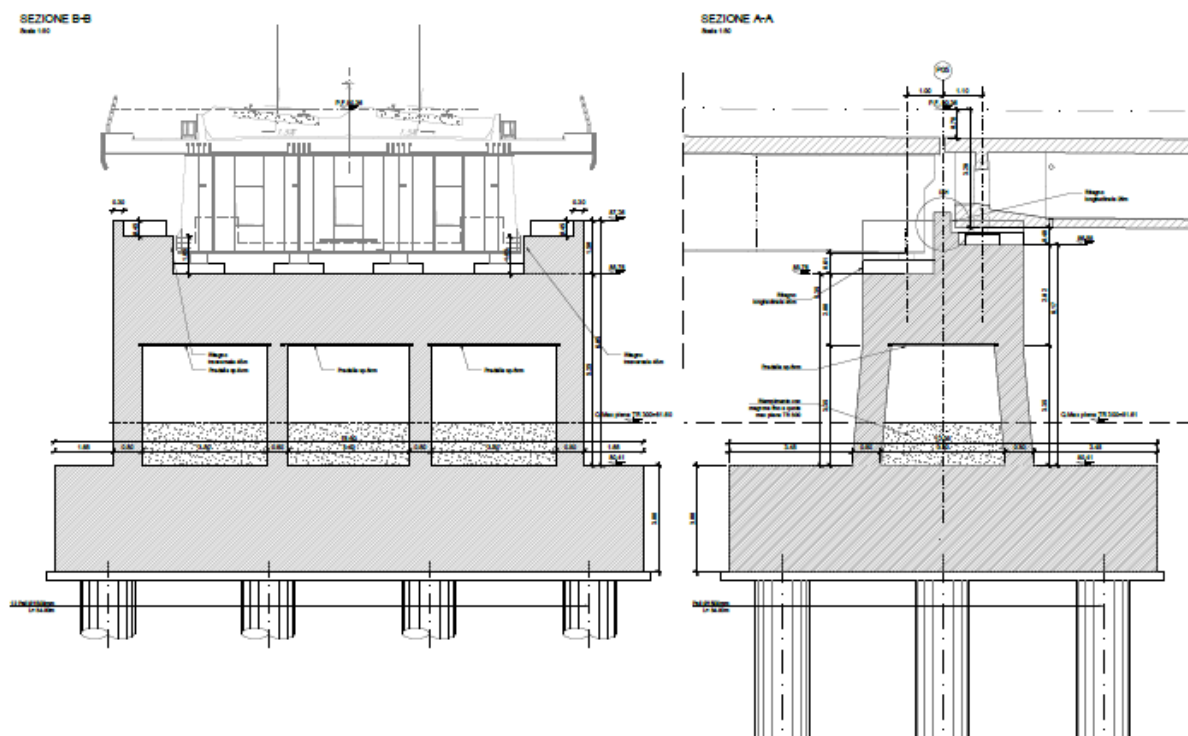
Sezione in direzione trasversale e longitudinale rispetto all'asse del viadotto pile P5
